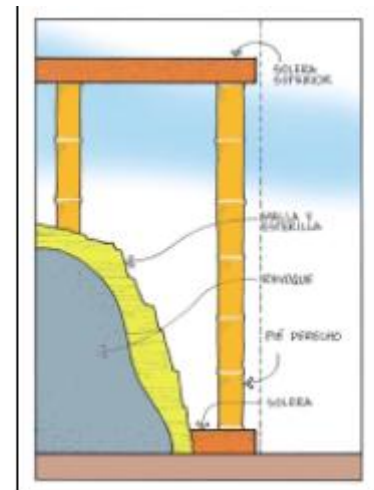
Detalle de unión de muros no estructurales de Bahareque encementado.
